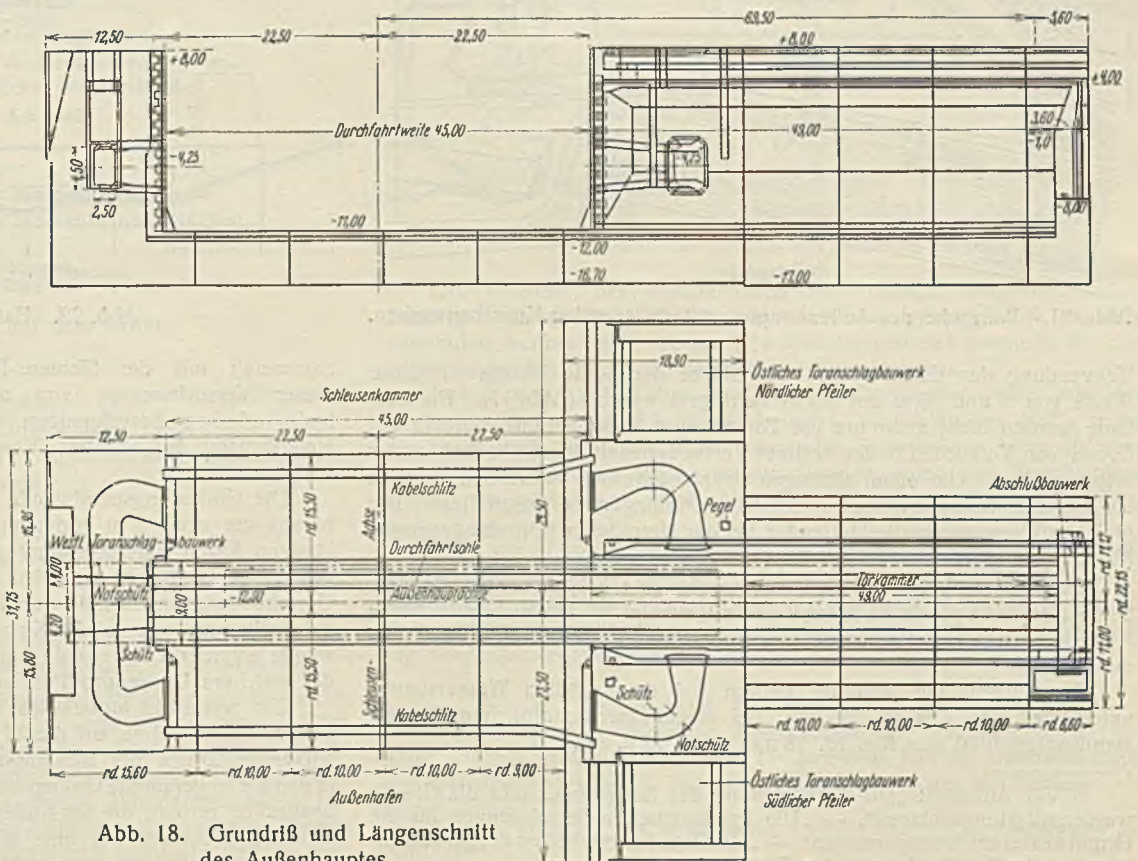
Grundriß und Längsschnitt des Außenhauptes.
